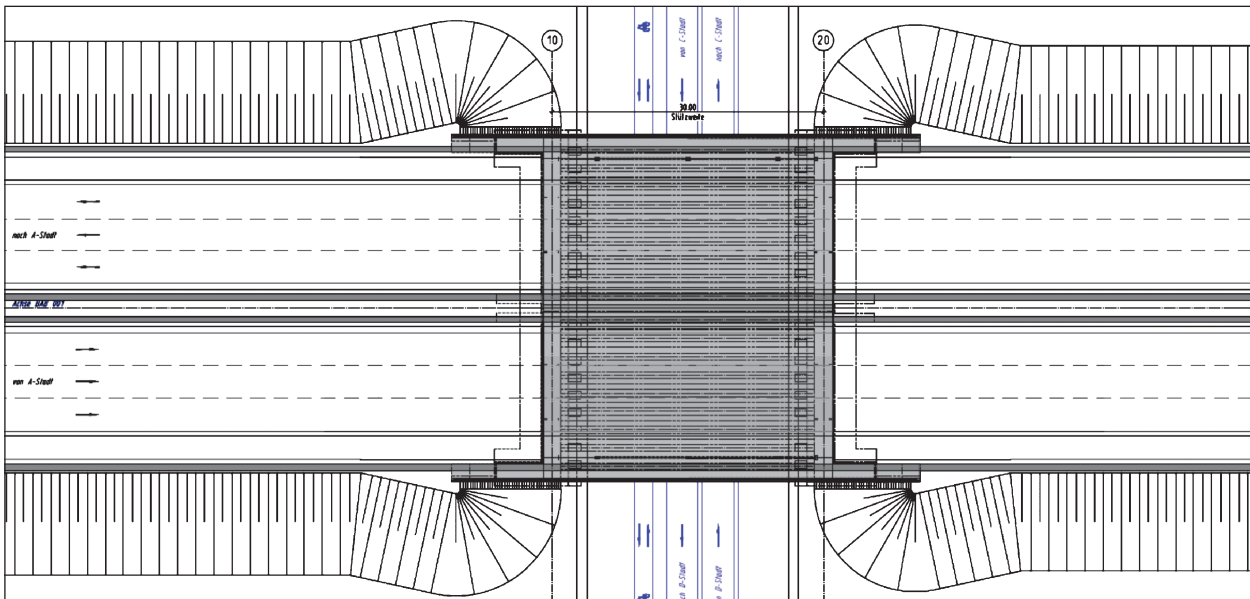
Grundriss Bauwerk 1 – Rahmen bis 30 m Stützweite
